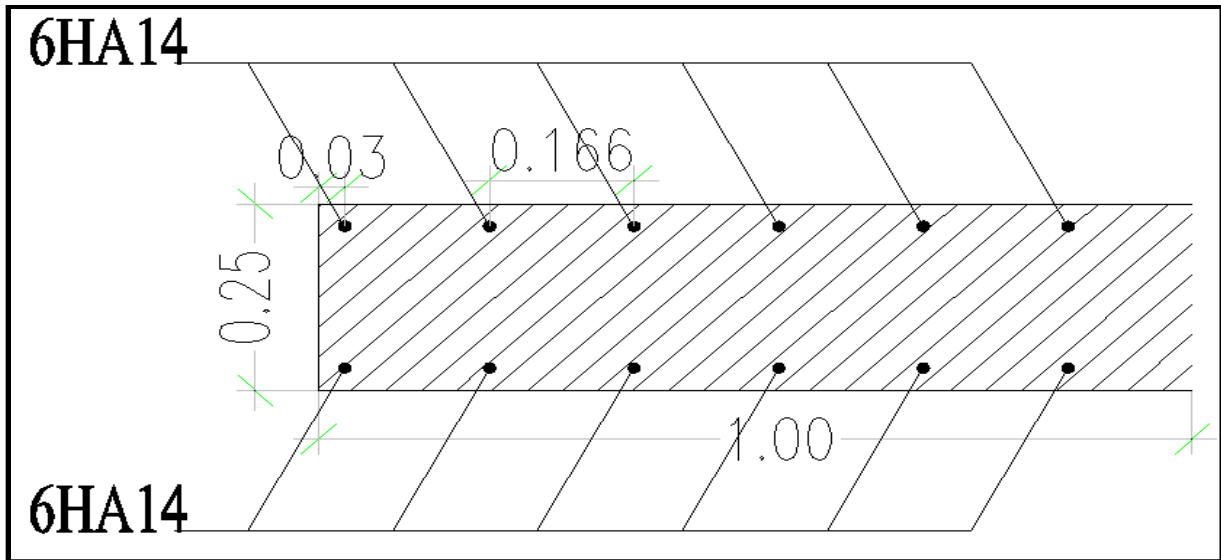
Schéma de ferrailage transversal de la dalle
